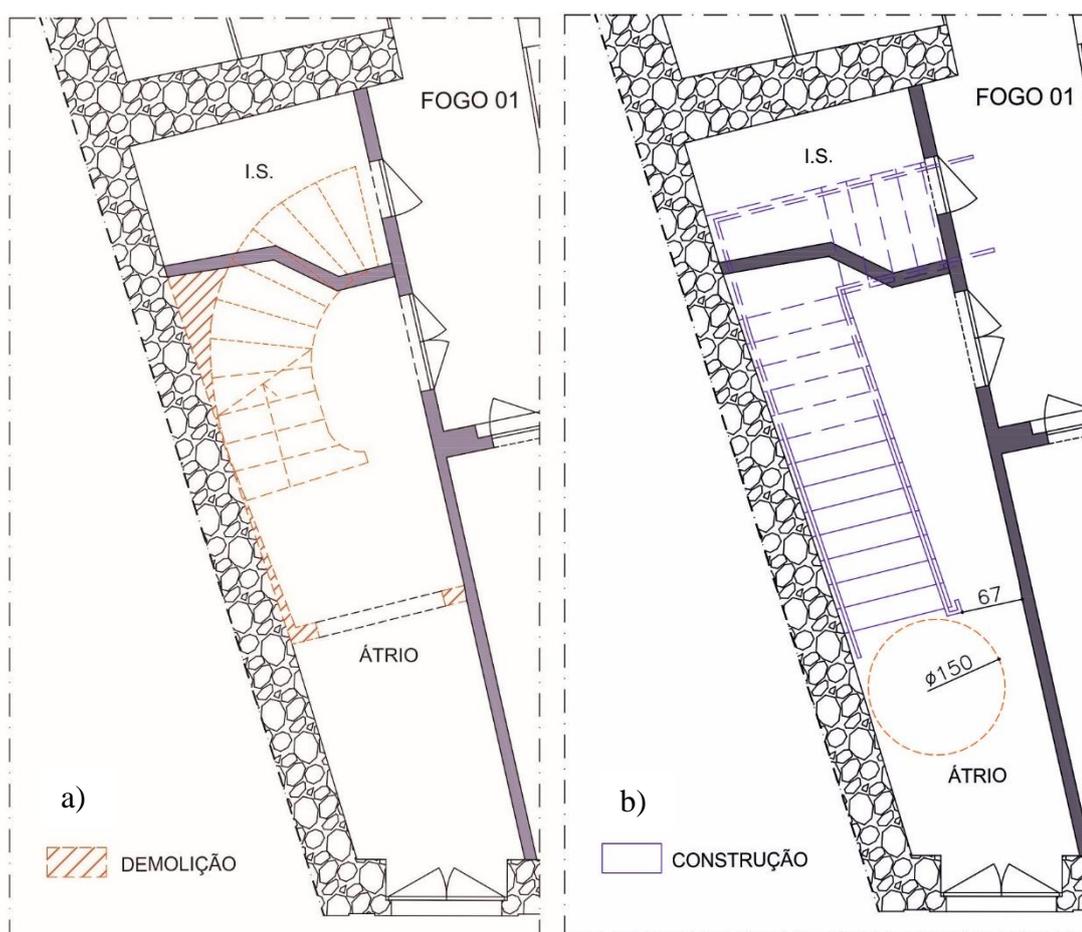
a) e b): Exemplo da reconstrução da escada do pavimento Rés-do-chão
